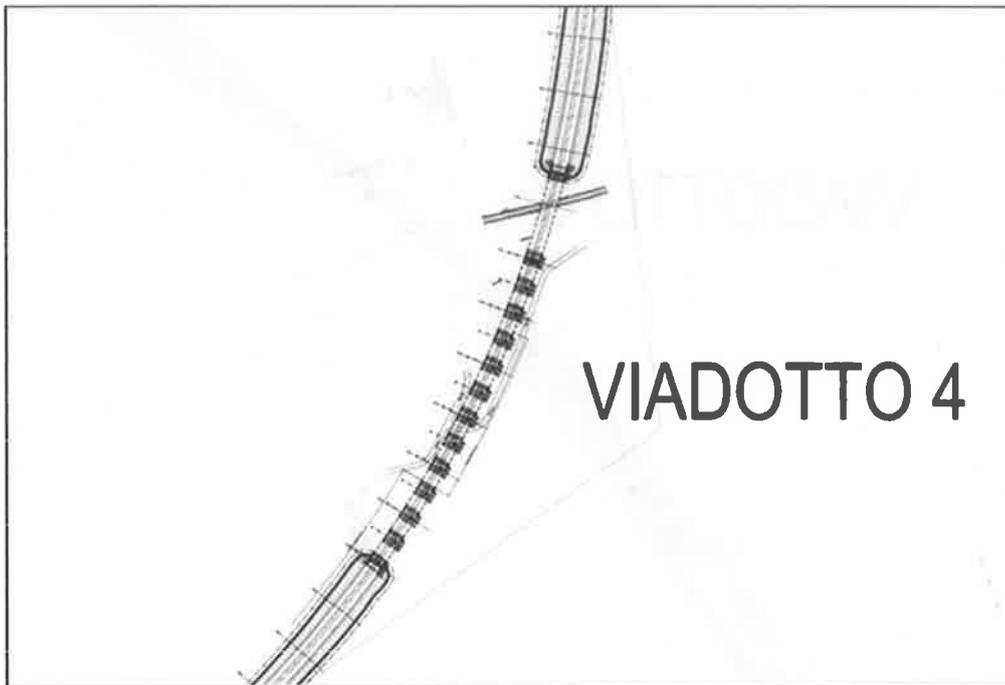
Sviluppo in pianta del viadotto VI02
